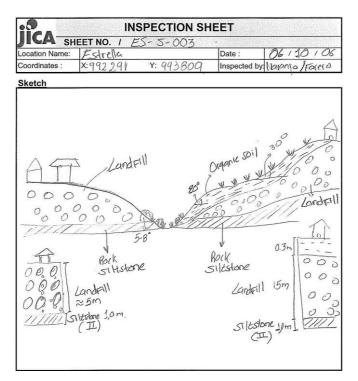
Esquema de la Sección Transversal de la Quebrada La Estrella (ES-S-003)
